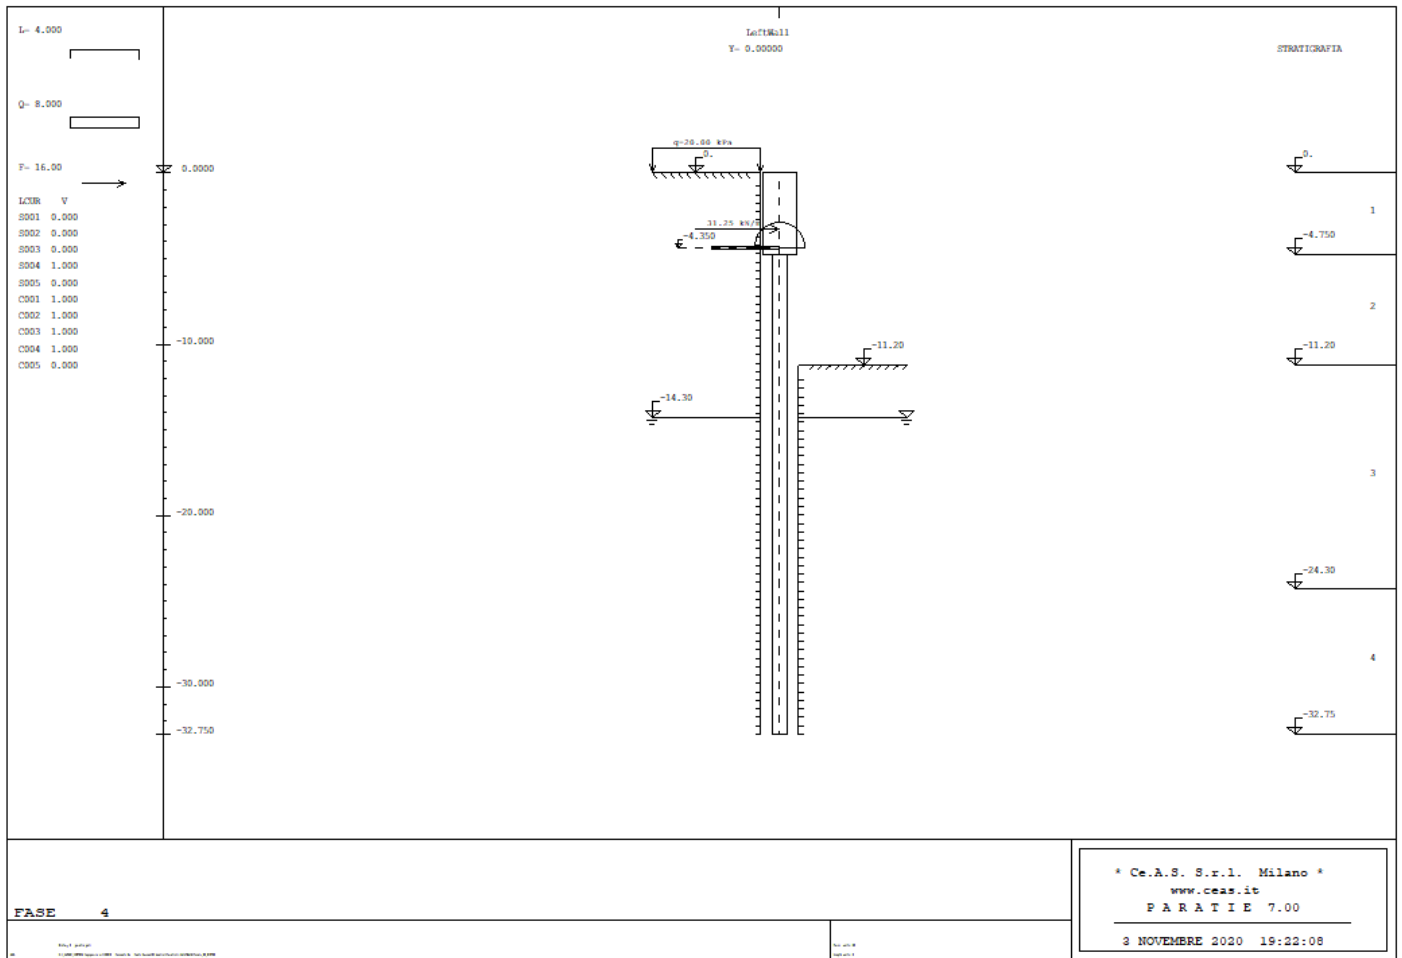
Fase 4 – Scavo fino a -11.2 (scalzamento)
